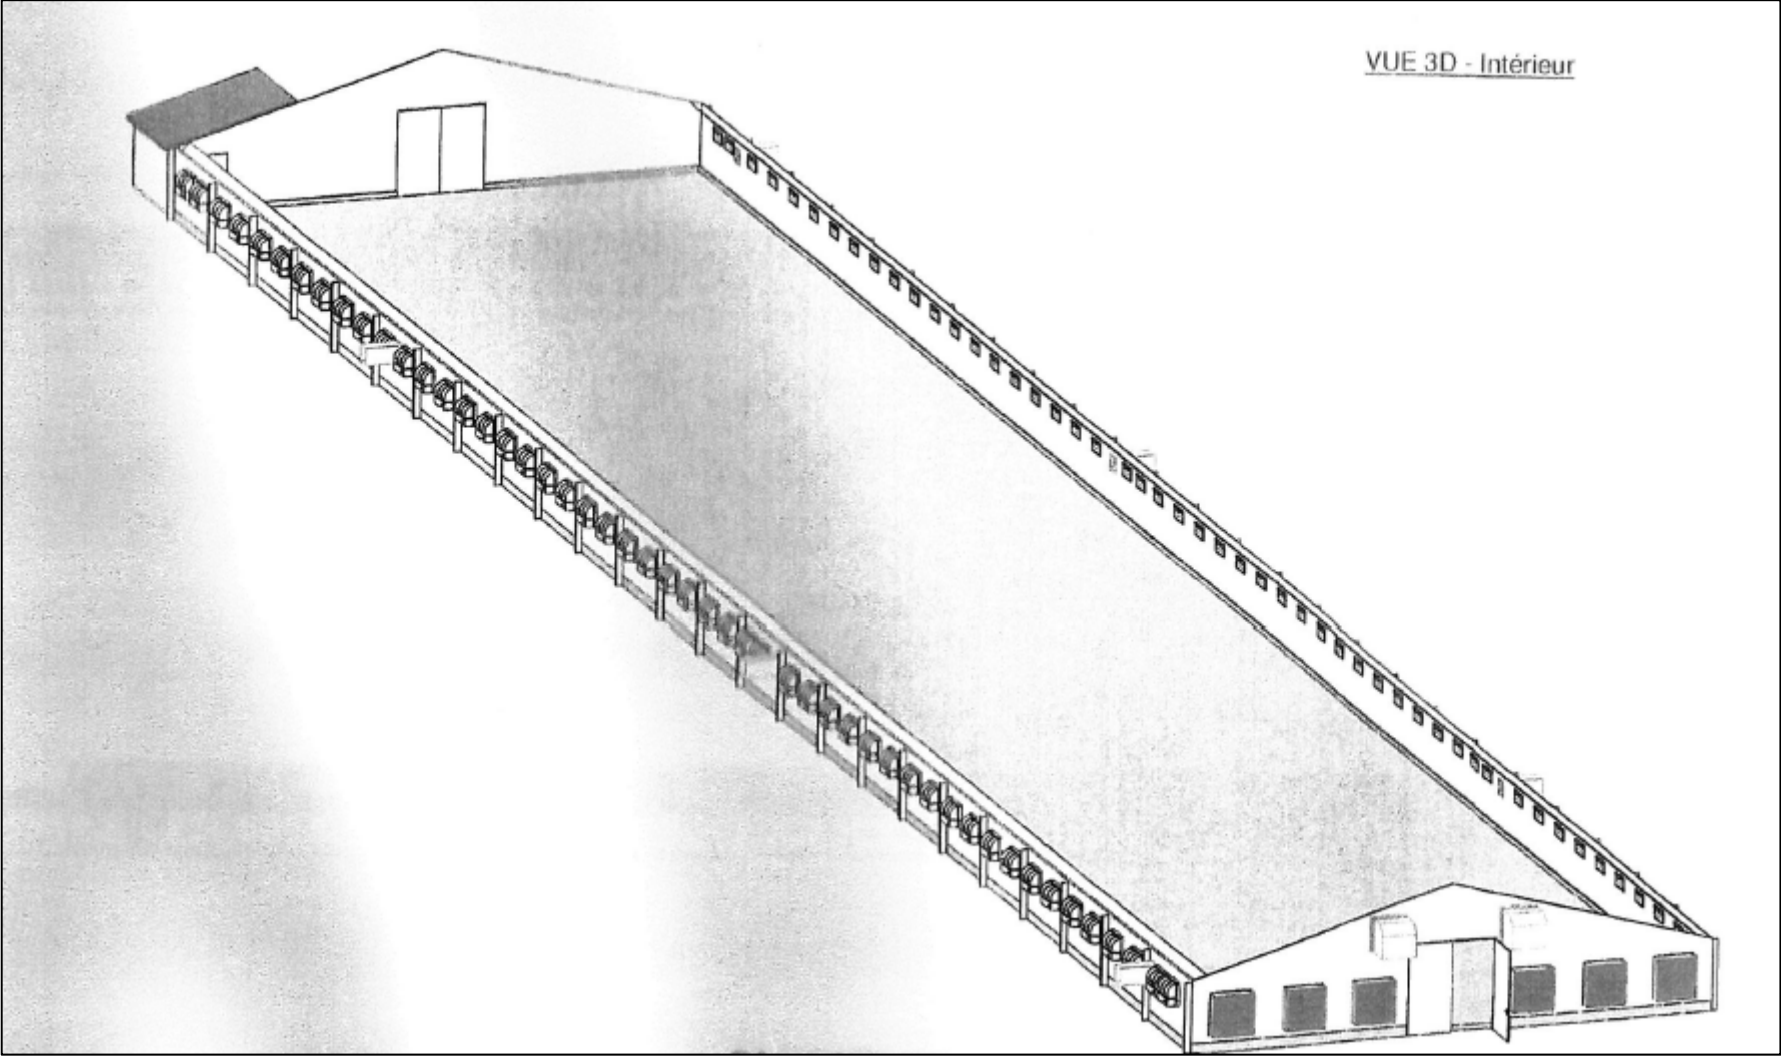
Plans du nouveau bâtiment volailles (extrait du permis de construire)
